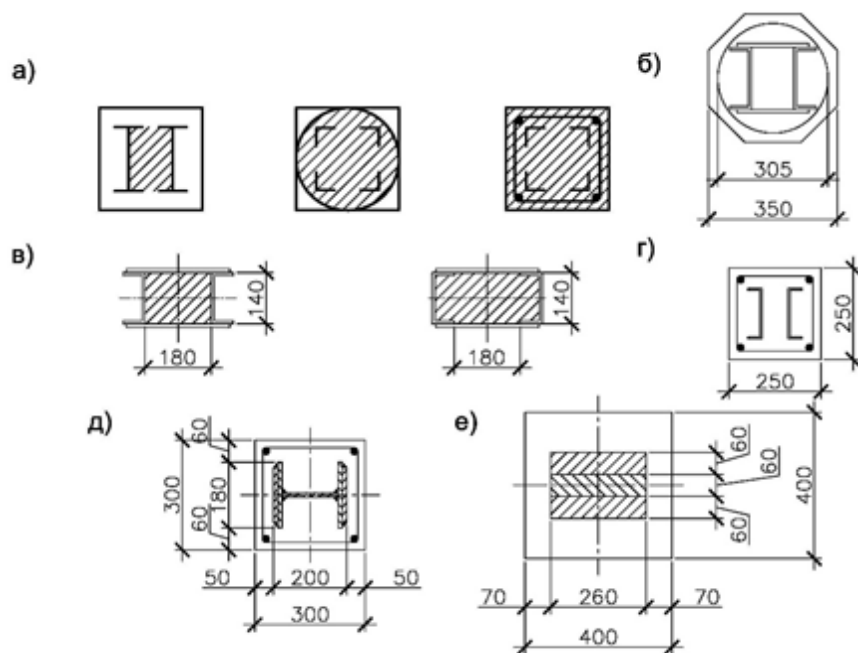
Примеры поперечных сечений сталежелезобетонных колонн с жесткой арматурой, которые были использованы в исследованиях ученых: а) проф. Эмпергер; б) проф. Залигер, в) проф. Мемлер; г) проф. Гелер и проф. А.П. Васильев; д) к.т.н. Э.А. Житницкая; е) к.т.н. А.Н. Егоров
